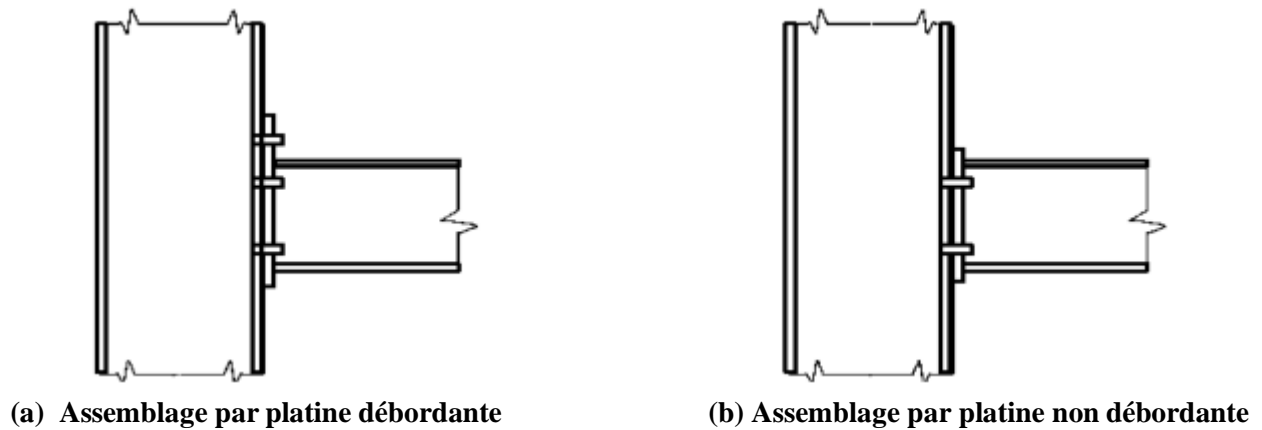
Assemblage poteau poutre par platine d'about boulonnée.[9]
